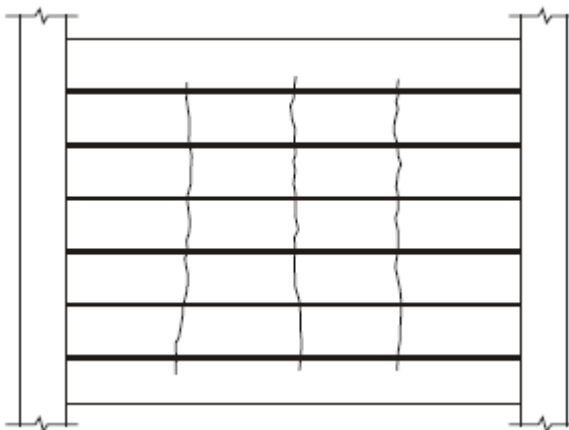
Fissuras de flexão em parede estrutural
